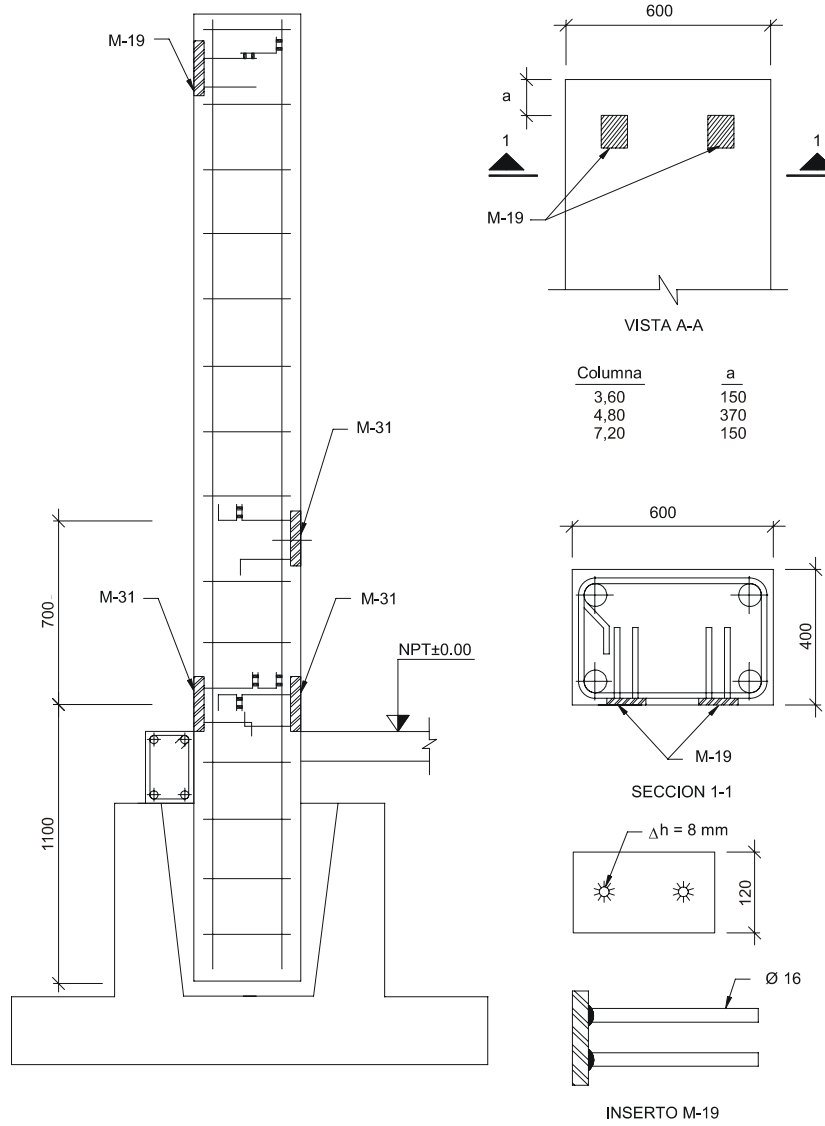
Unión de viga-zapata prefabricada V-1, con cimiento y columna.
